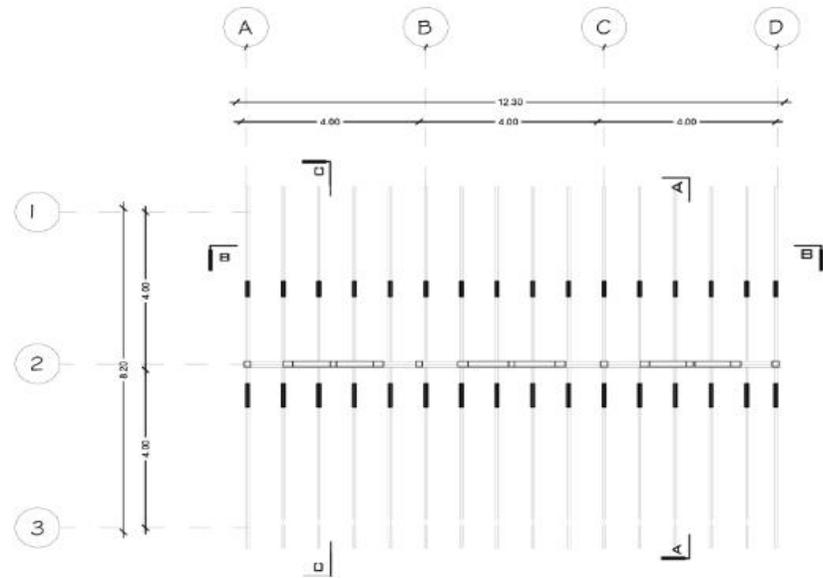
Planta de cubierta(Tipología 1)-Esc:1/100Fuente:
